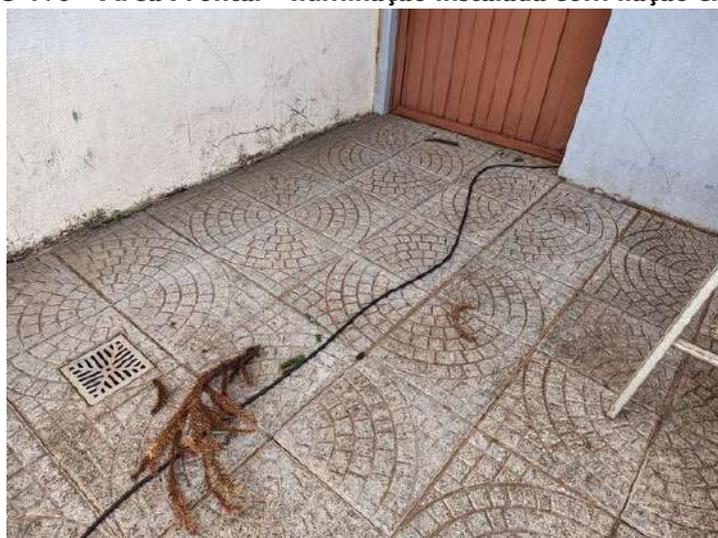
Área Frontal – Iluminação instalada com fiação exposta
